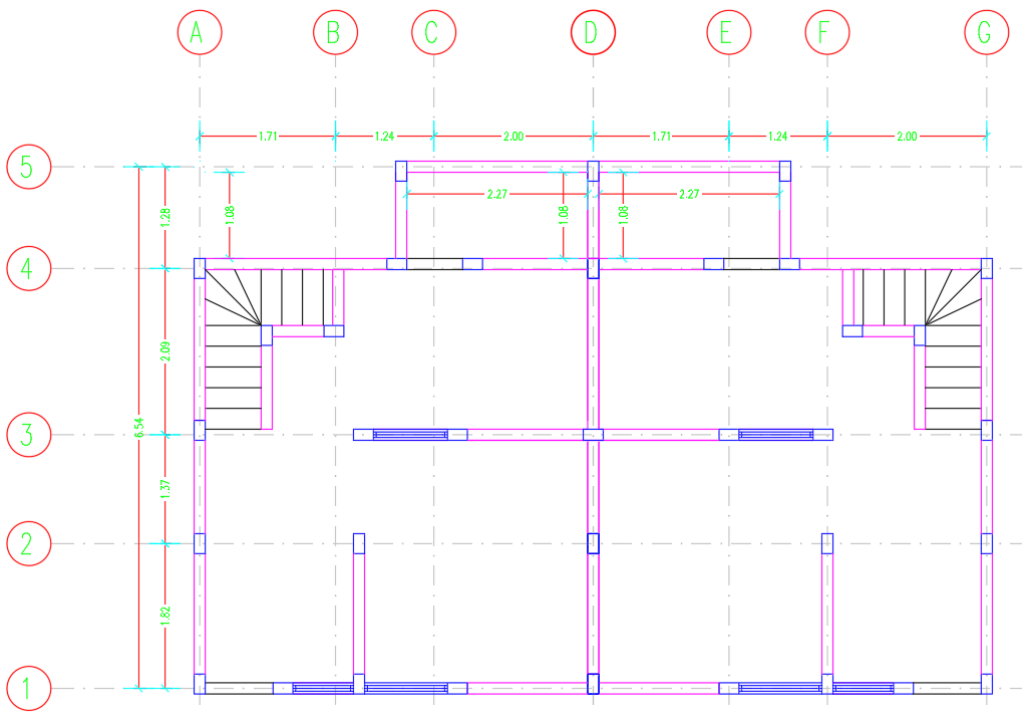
Planta baja estructura con mampostería confinada. Fuente: Propia
